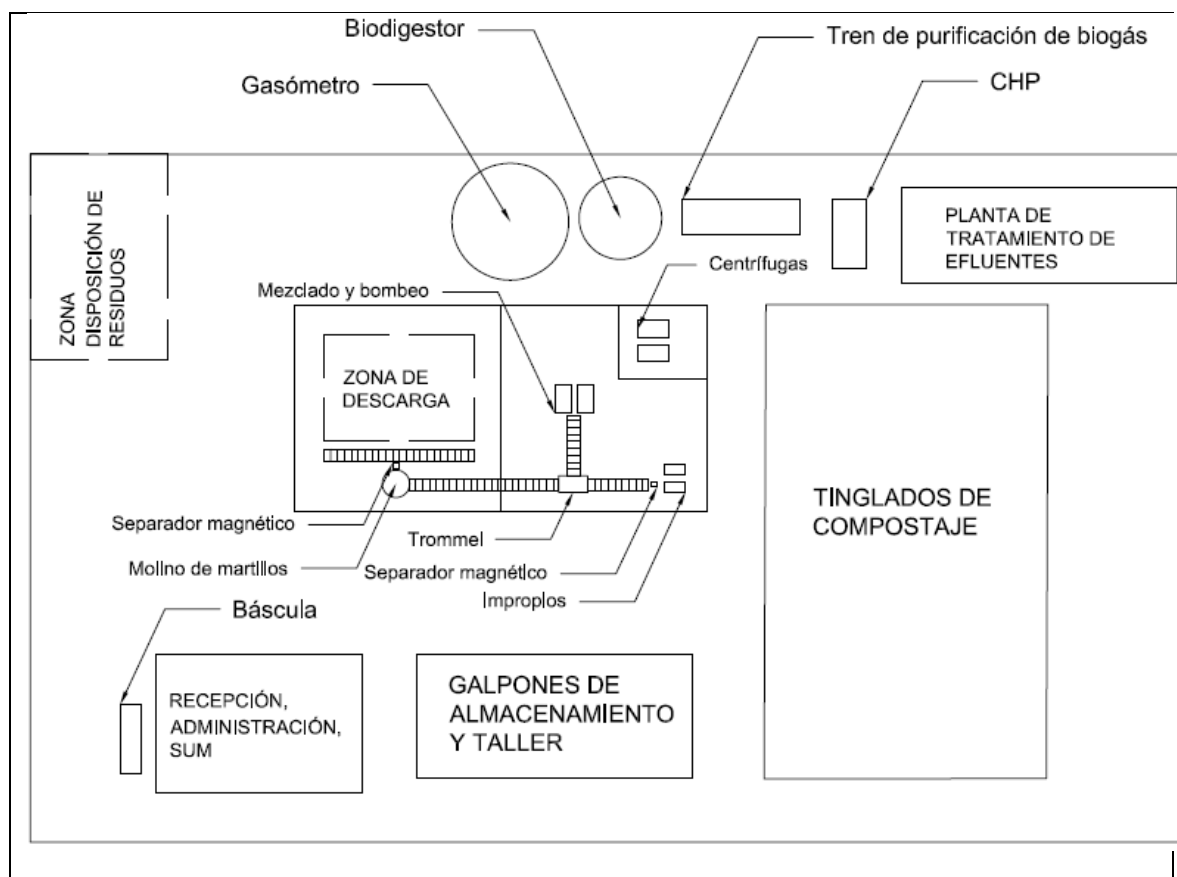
Layout de planta (predio de aprox. 1,7 ha)
